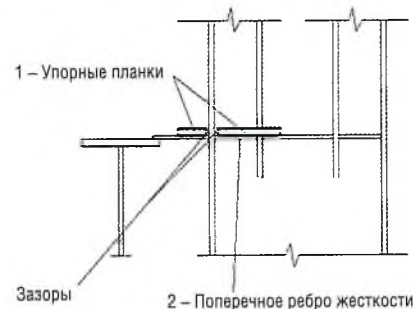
Разрушение сварного углового шва крепления поперечного ребра жесткости к поясному листу колонны
